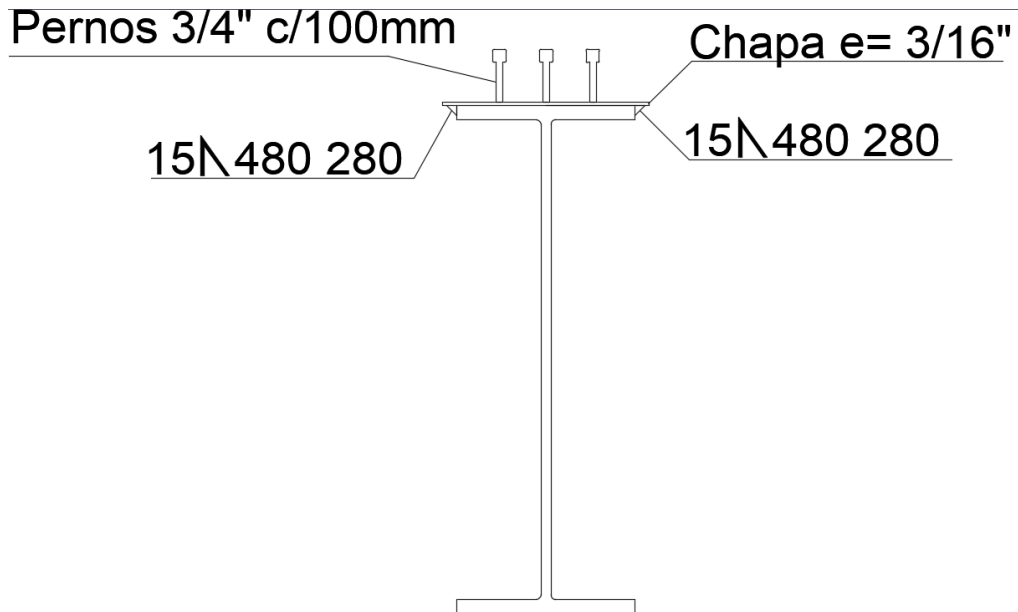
Detalle unión entre vigas longitudinales centrales y losa del tablero con chapa soldada.
